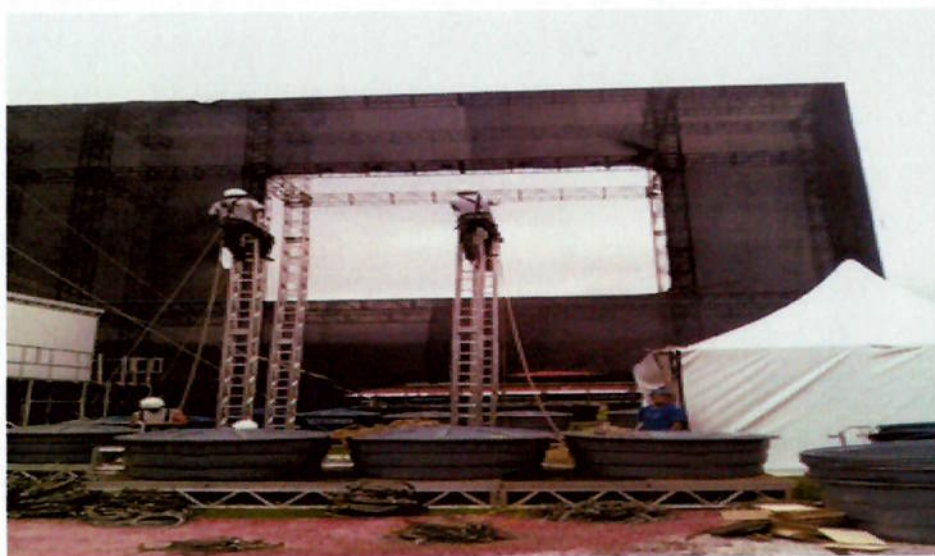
Montagem de estruturas auxiliares – torres de retro-projeção –
